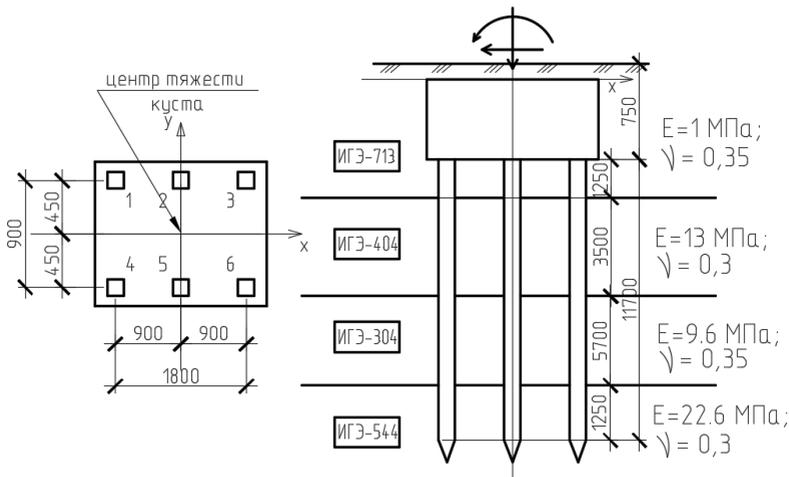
Схема к расчету осадки свайного фундамента
